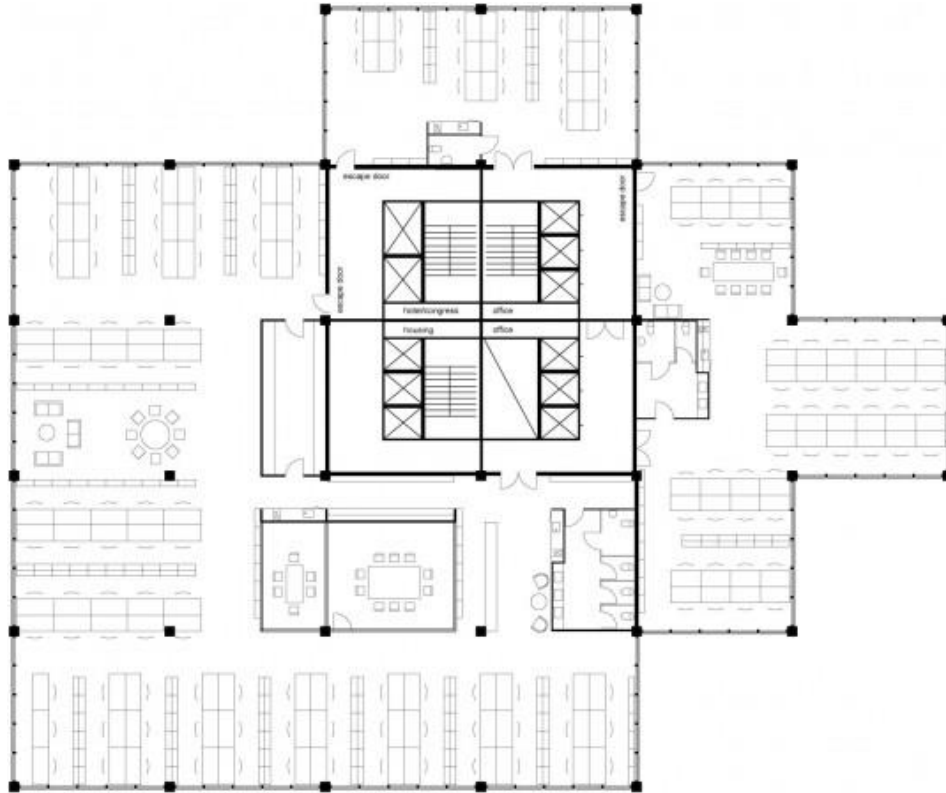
Planta tipo. Fuente: Sky Village Project. Arquitectura modelo
